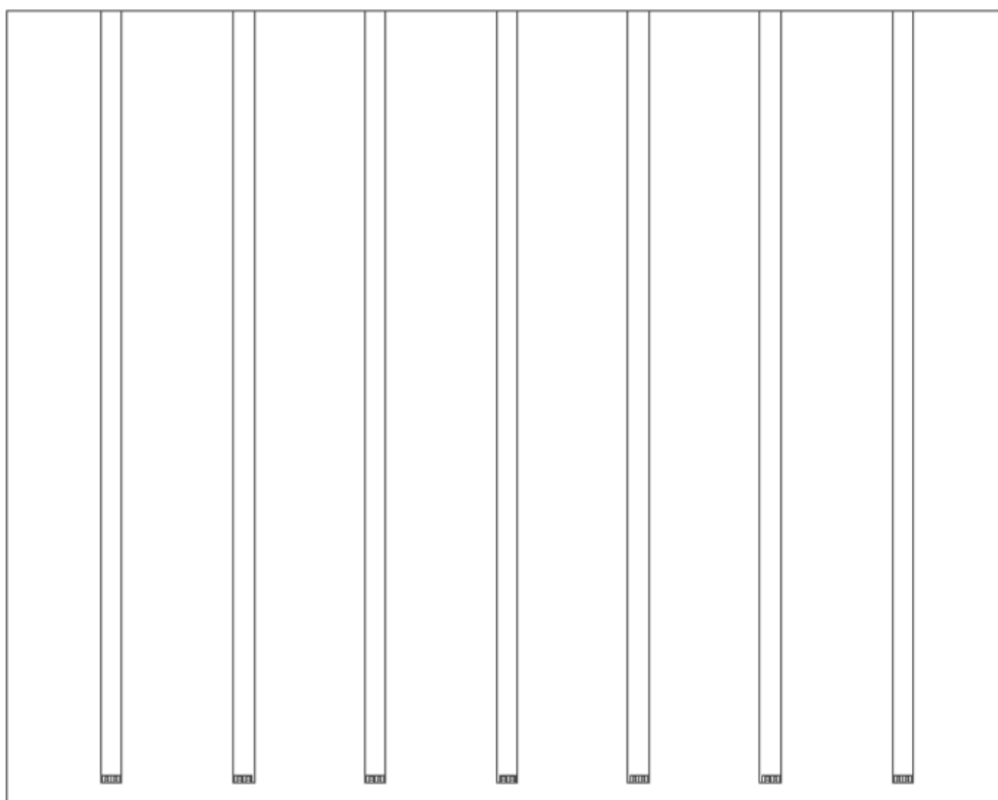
Triple réseau - Coupe verticale - Pose sur COB
